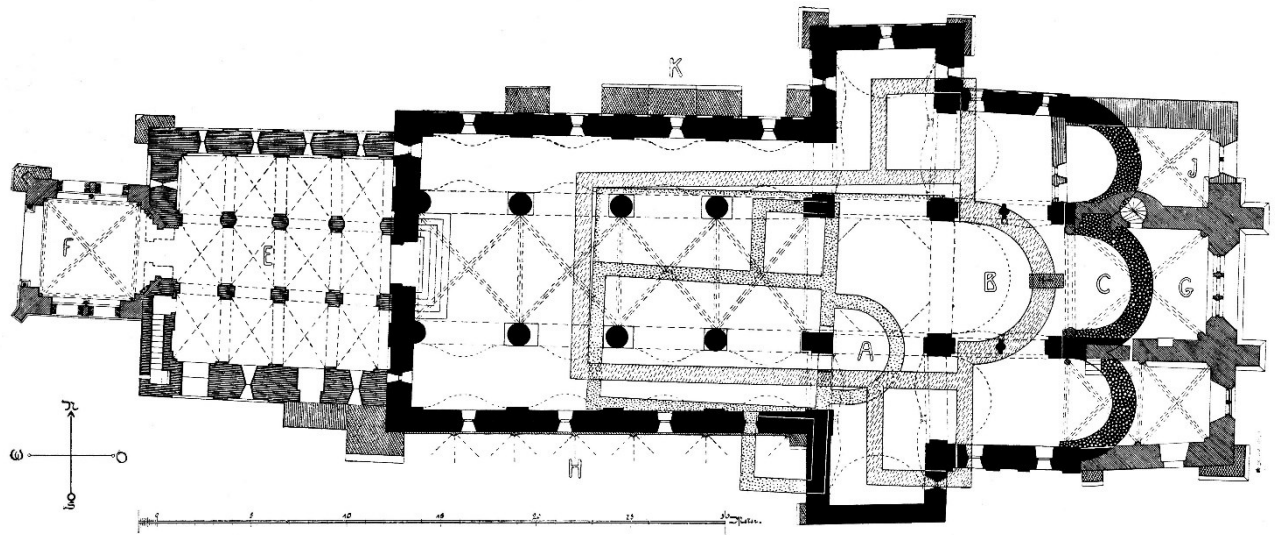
Grundriss der Abteikirche Romainmôtier
